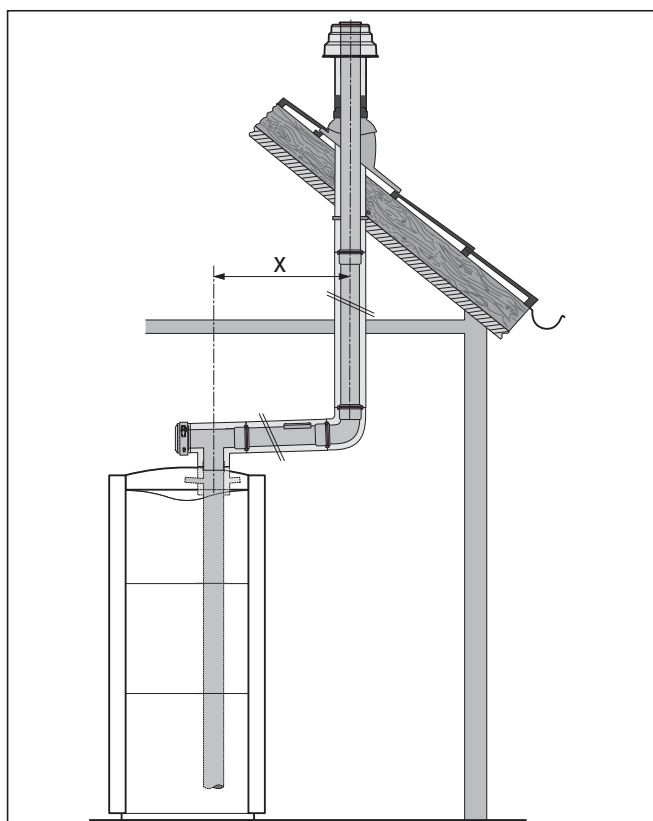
Exemple de montage d'une traversée de toit verticale avec pièce en T d'inspection.
